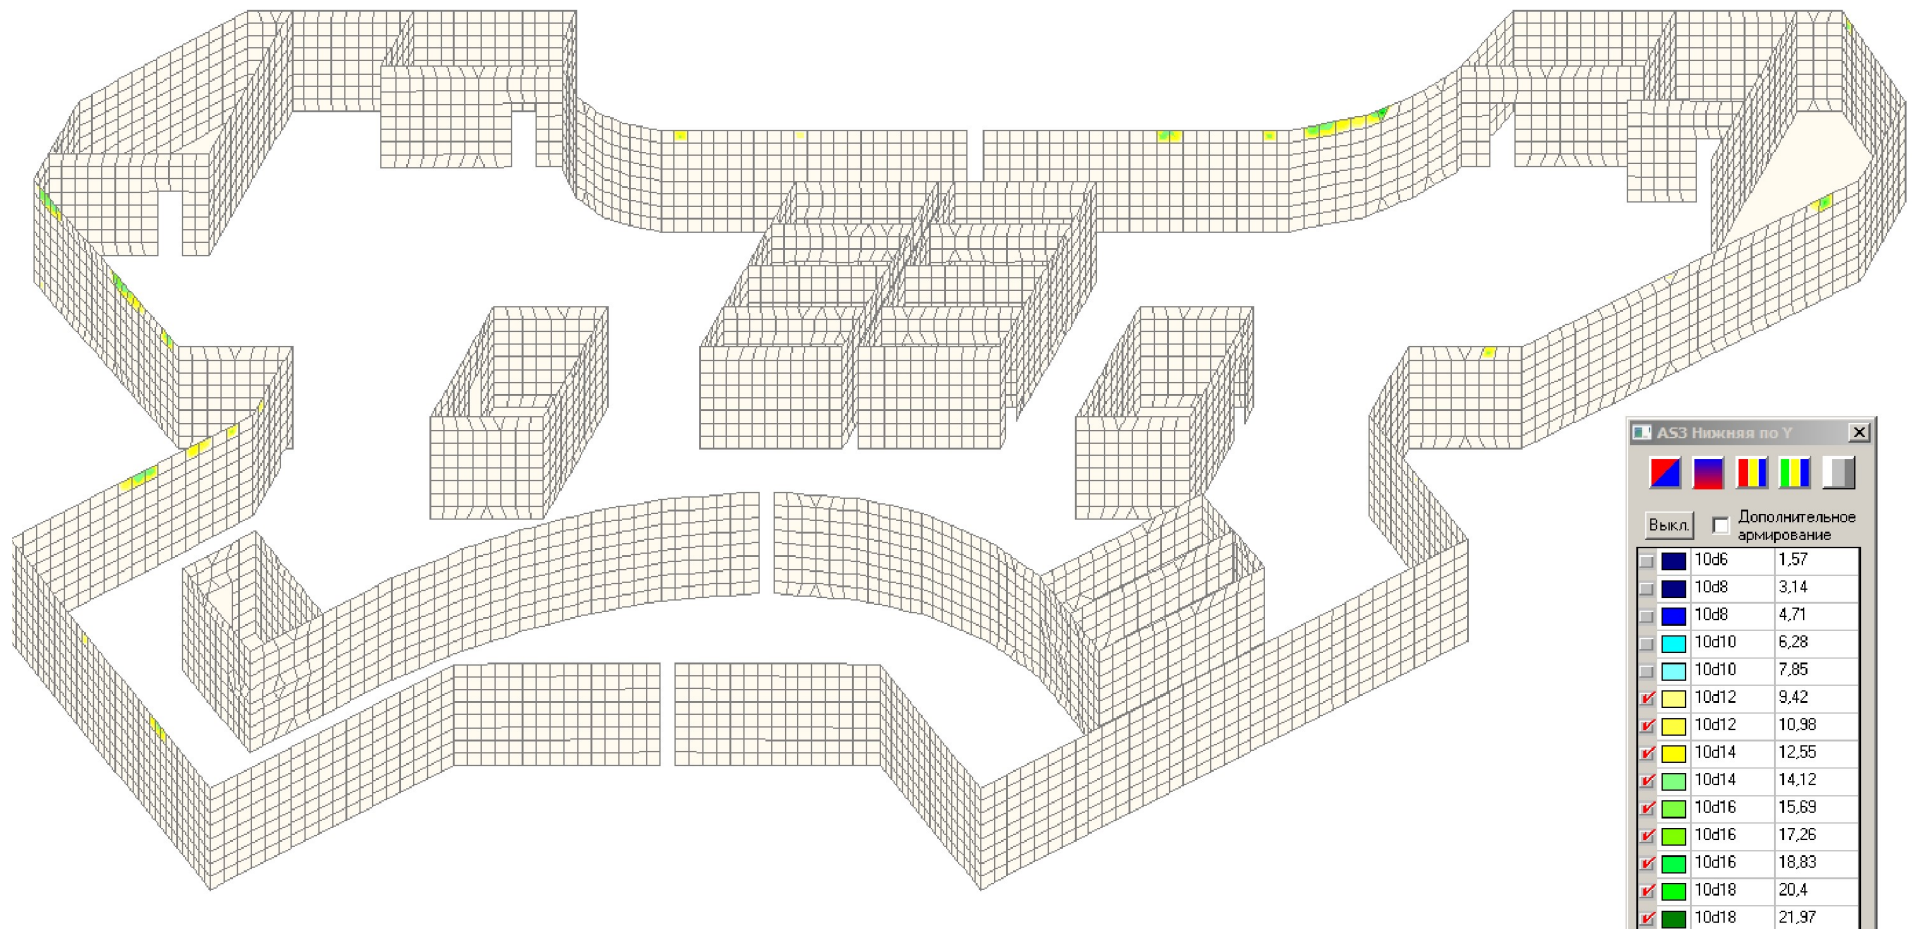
Армирование стін сходової клітки (горизонтальна арматура)
